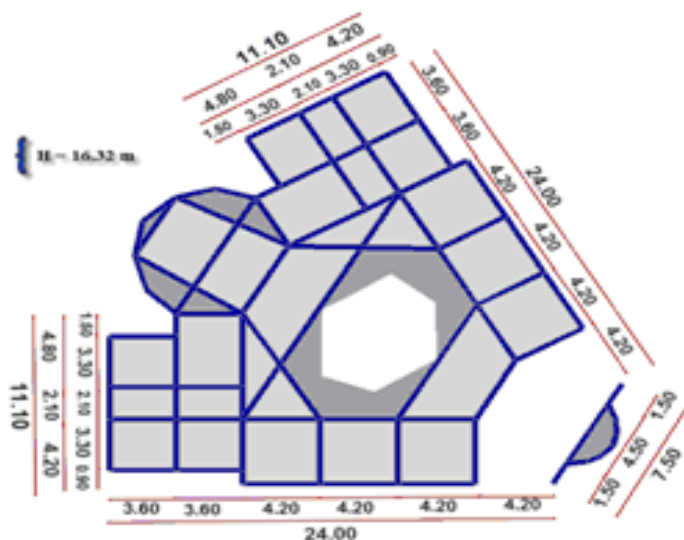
Vue en plan 2D, le plancher de 3^{ème} étage (terrace1)
